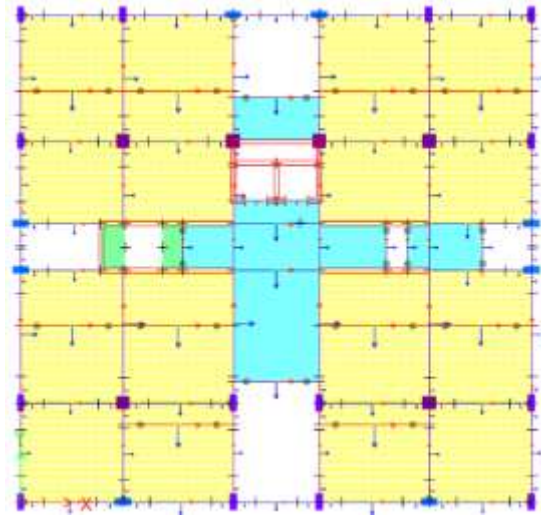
Vista en planta de modelo de Edificio de 14 pisos
